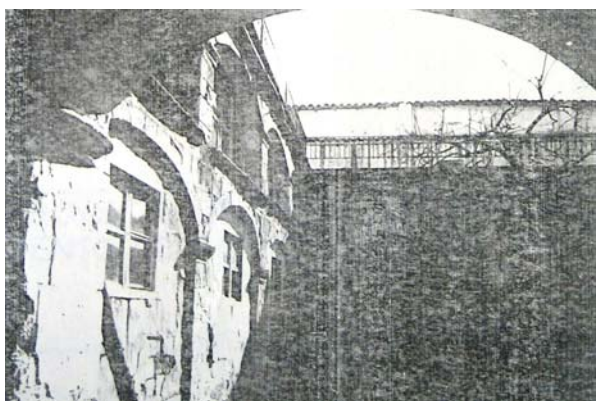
Convento de San Antonio. Detalle constructivo de forjado. AGA, IDD (3)115 caja 26/1637.
